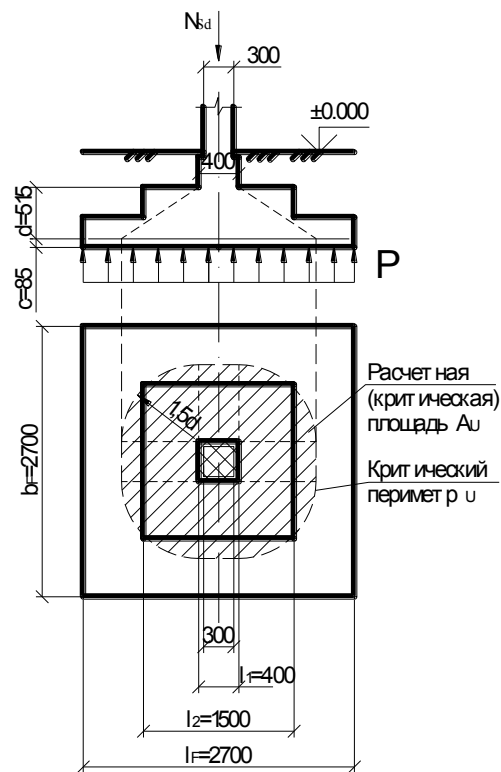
Схема фундамента с высокой стаканной частью к расчету на продавливание
